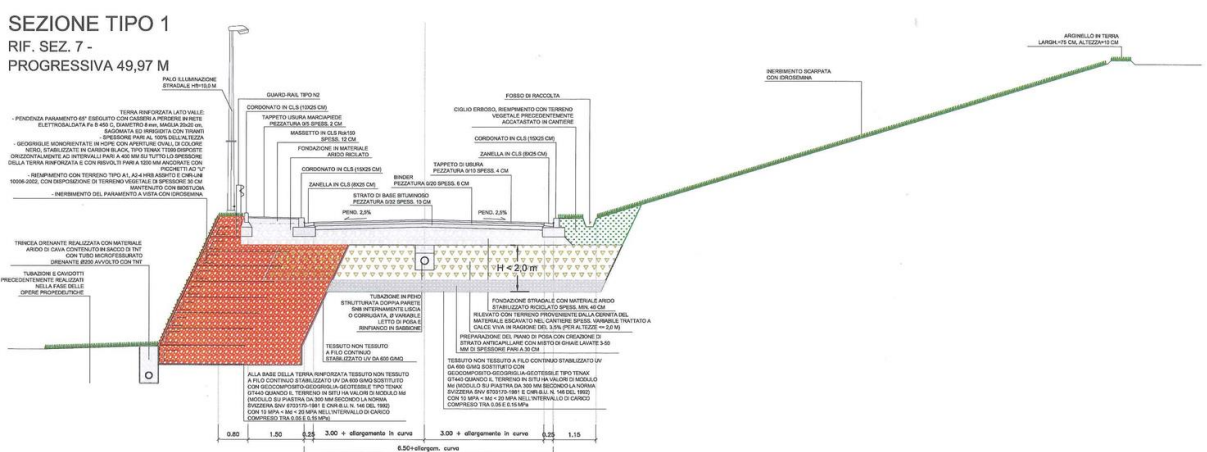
SEZIONE TIPO DI PROGETTO CON TERRA RINFORZATA A VALLE
